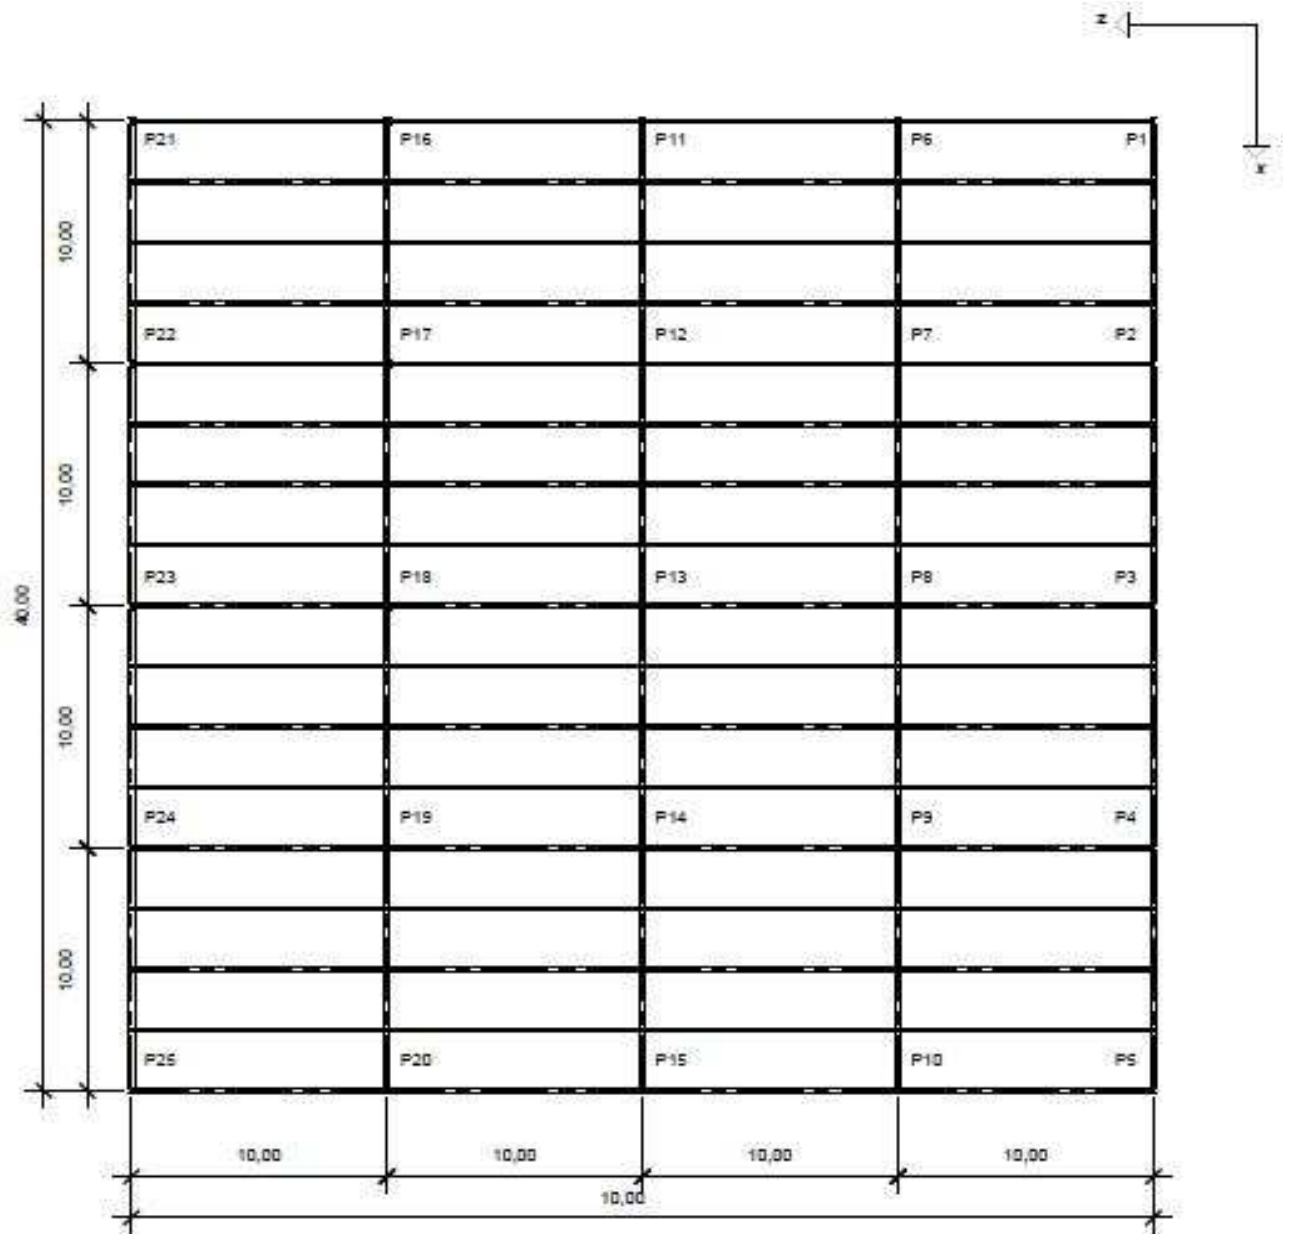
Planta baixa do modelo estrutural do edifício em estudo (dimensões em m)
